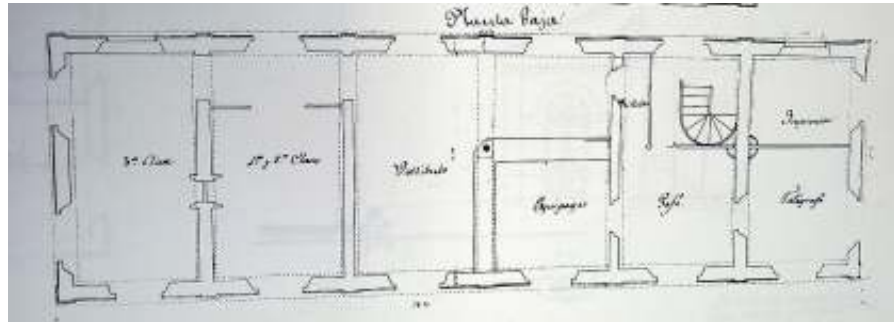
Planta baja. Nuevo proyecto estación de Lugo.(I. Aguilar).
